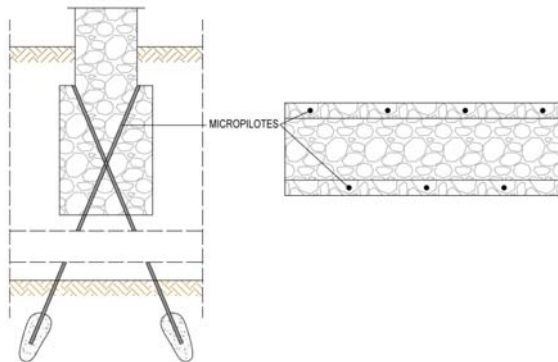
Refuerzo 3 mediante micropilotes de zapata corrida bajo muro. Fuente propia.
